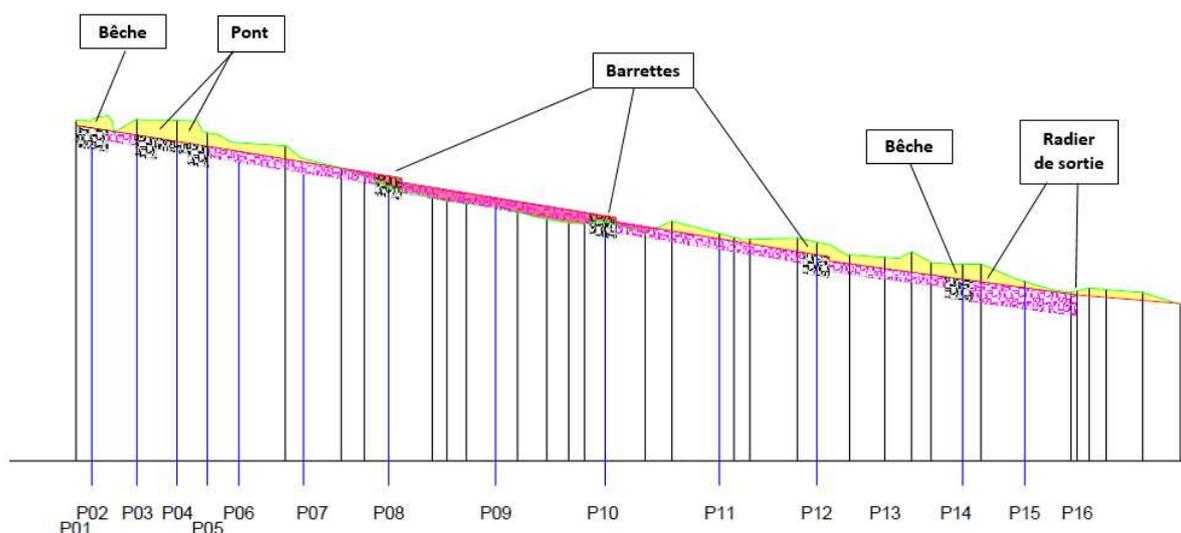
Position des ouvrages tranche 1 sur profil en long
